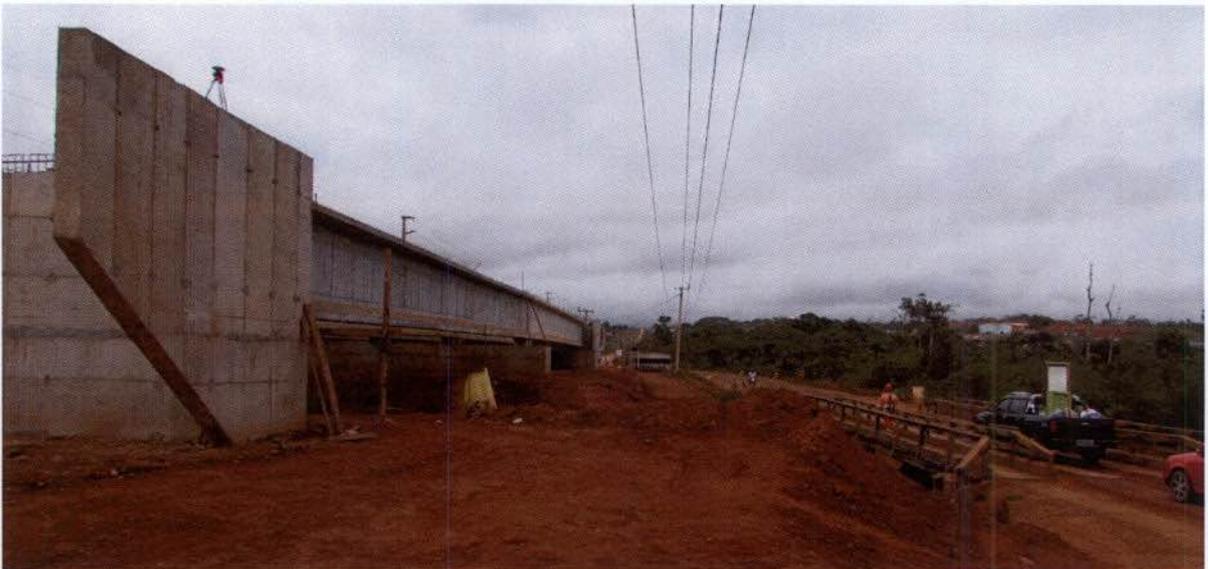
Ponte em construção e ponte atual da Transamazônica sobre o Igarapé Ambé, detalhe para o desnível entre ponte e via
